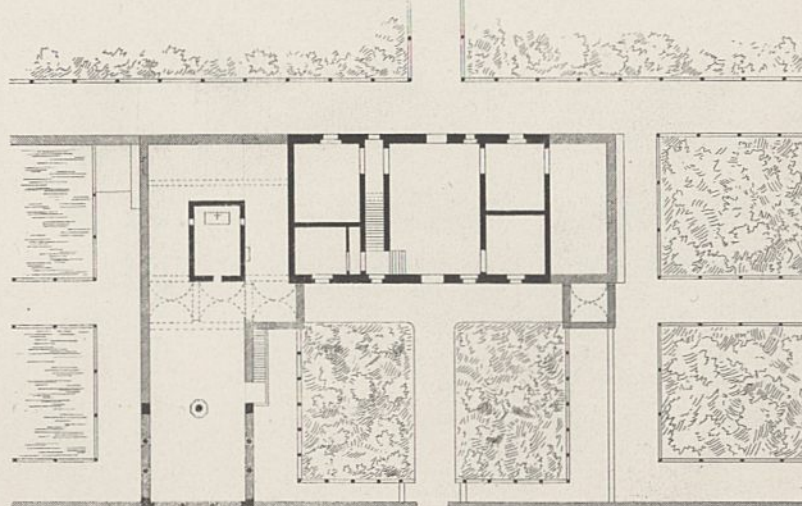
Grundriss der Villa Radič in Gravosa.
